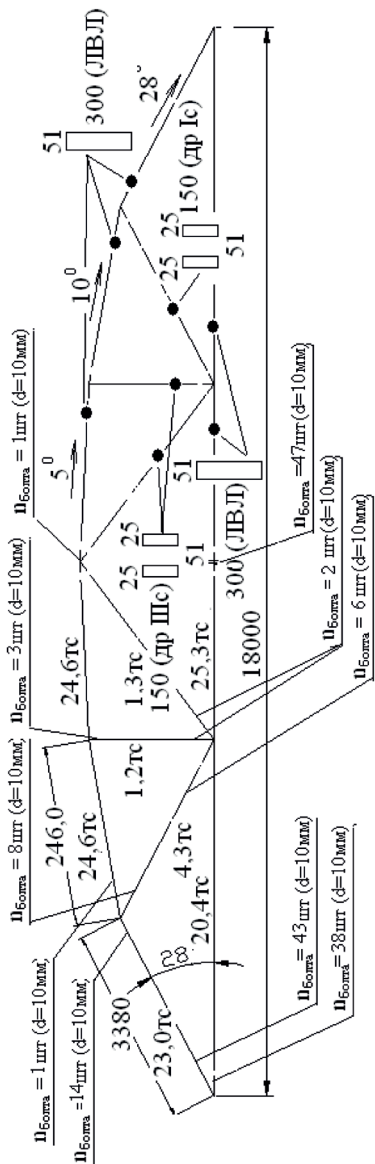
Предлагаемая конструкция фермы отдельно стоящего здания пролетом 18 м из ЛВЛ и древесины в Санкт-Петербурге
